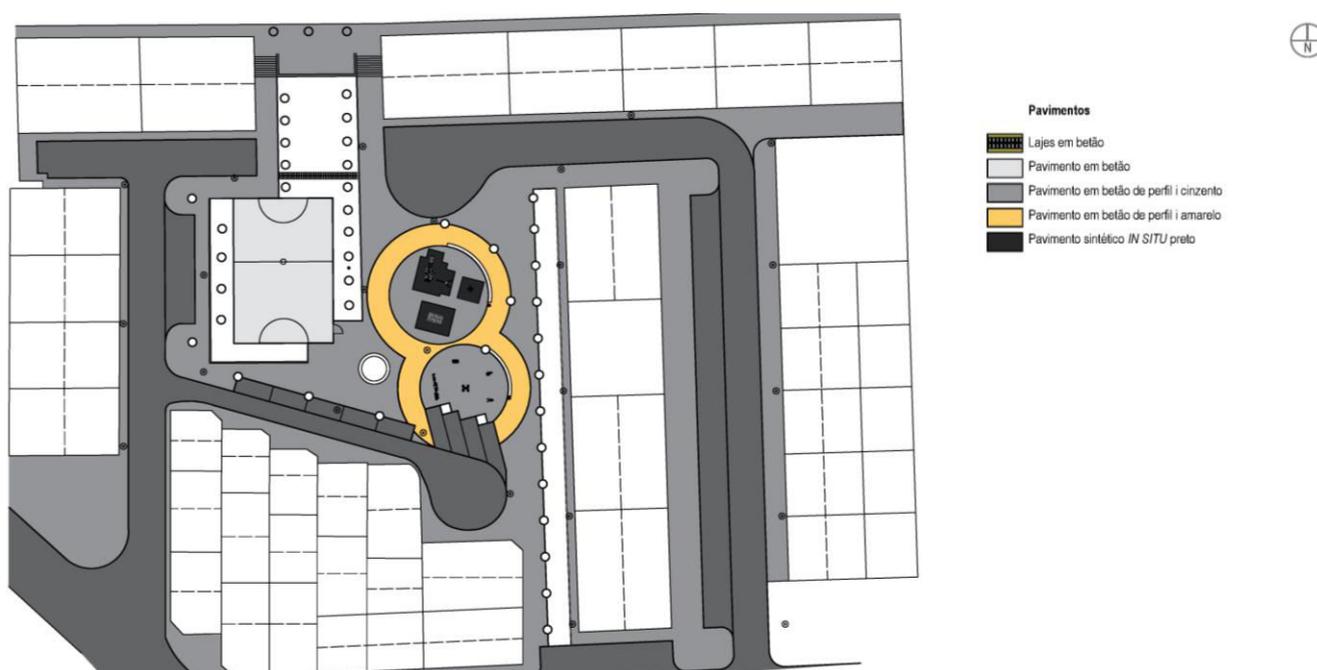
Planta de Pavimentos propostos para o Jardim Pinto e Granjo (Fonte: autora)
